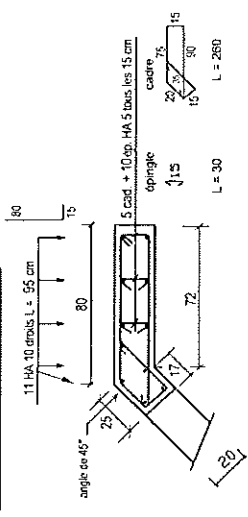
DETAIL DES SEMELLES FILANTES TYPE SF1 - SF2
